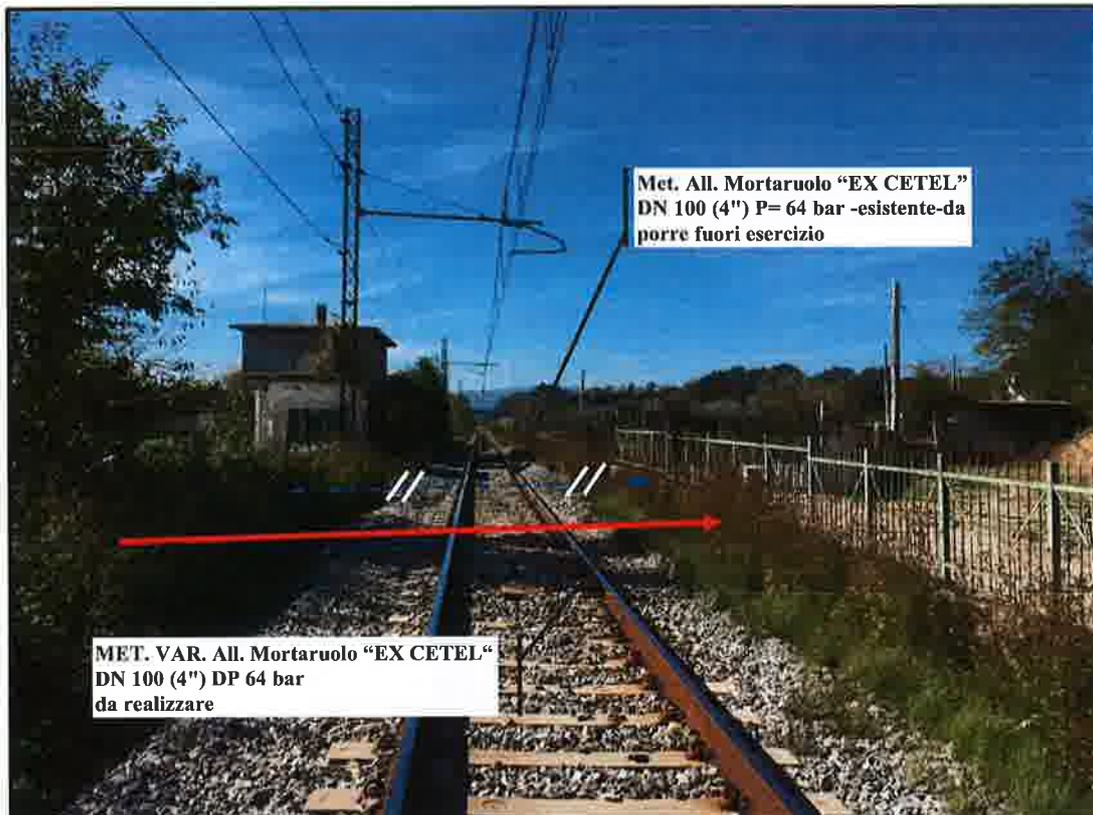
Vista variante metanodotto da realizzare e attraversamento Linea RFI
